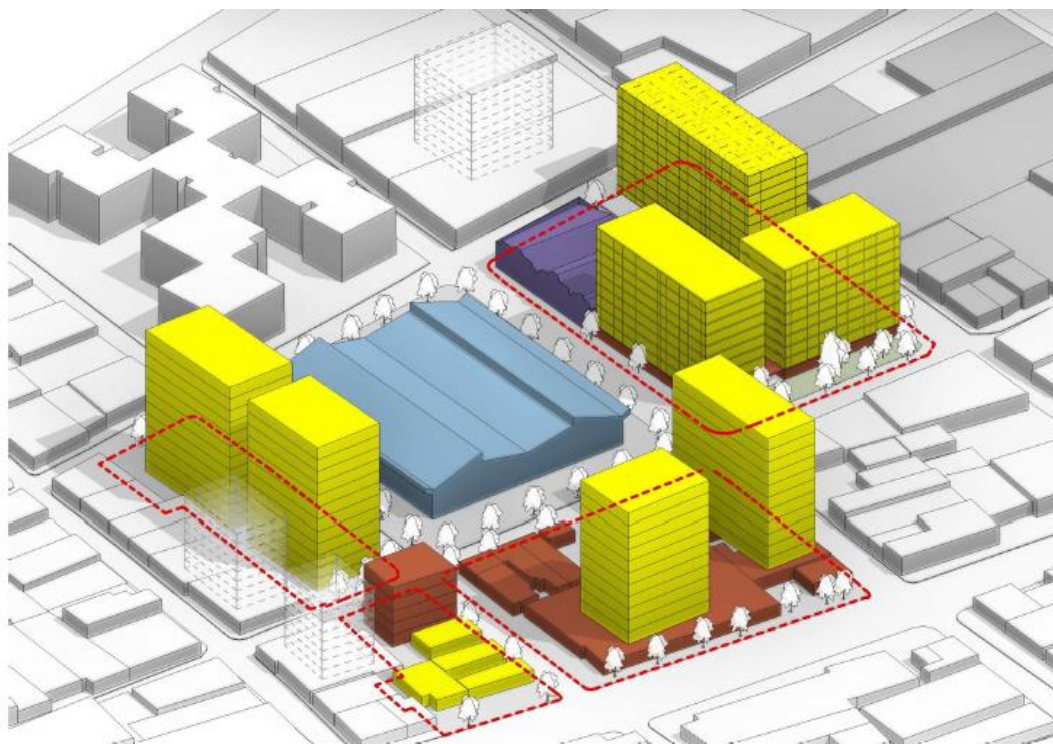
PF-9 Edificabilidad del plan parcial Barrio Abajo
